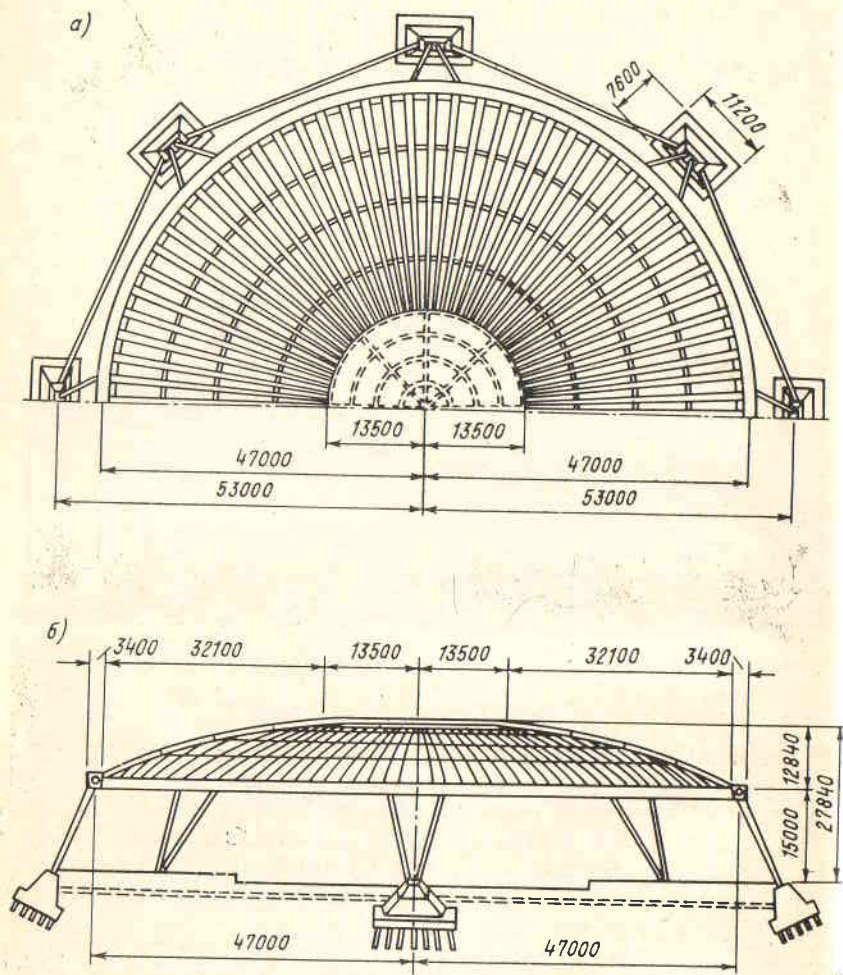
Купольное покрытие над зданием павильона в Белграде
